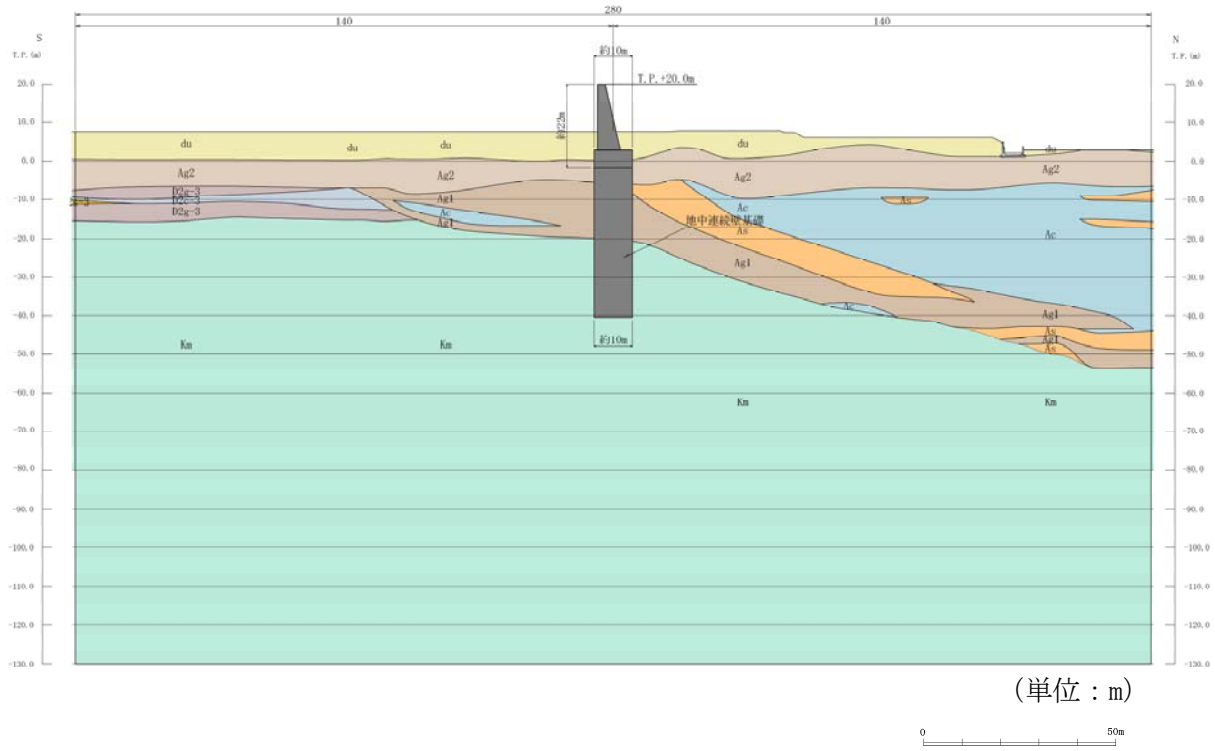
(1) 鉄筋コンクリート防潮壁 断面図(A-A断面)
